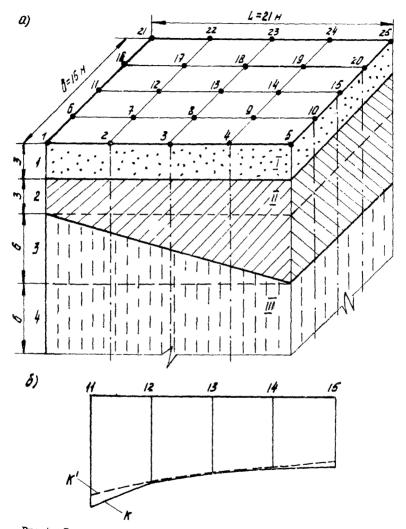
Расчетные схемы к примеру I: а — геологический разрез основания; б — эпора коэффициентов жесткости по среднему продольному сечению плиты.
